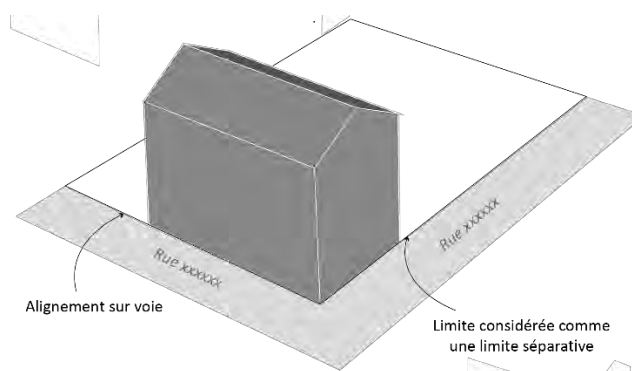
\_ Les constructions principales implantent leur façade principale sur voie.
